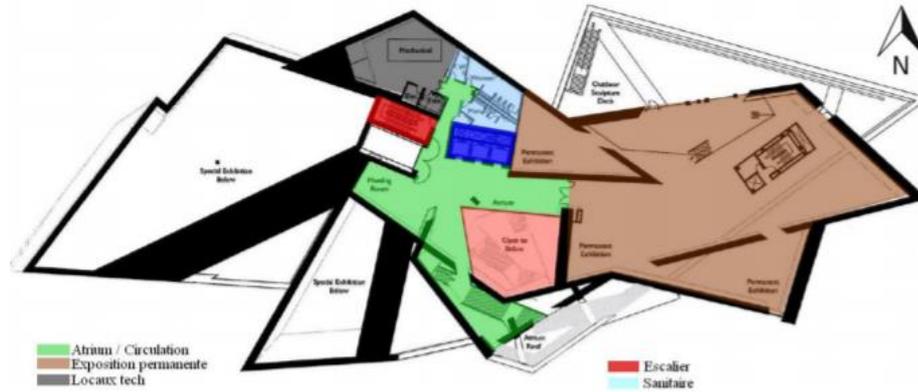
Plan 2ème étage. Source : www.archdaily.com, édité par l'auteur
